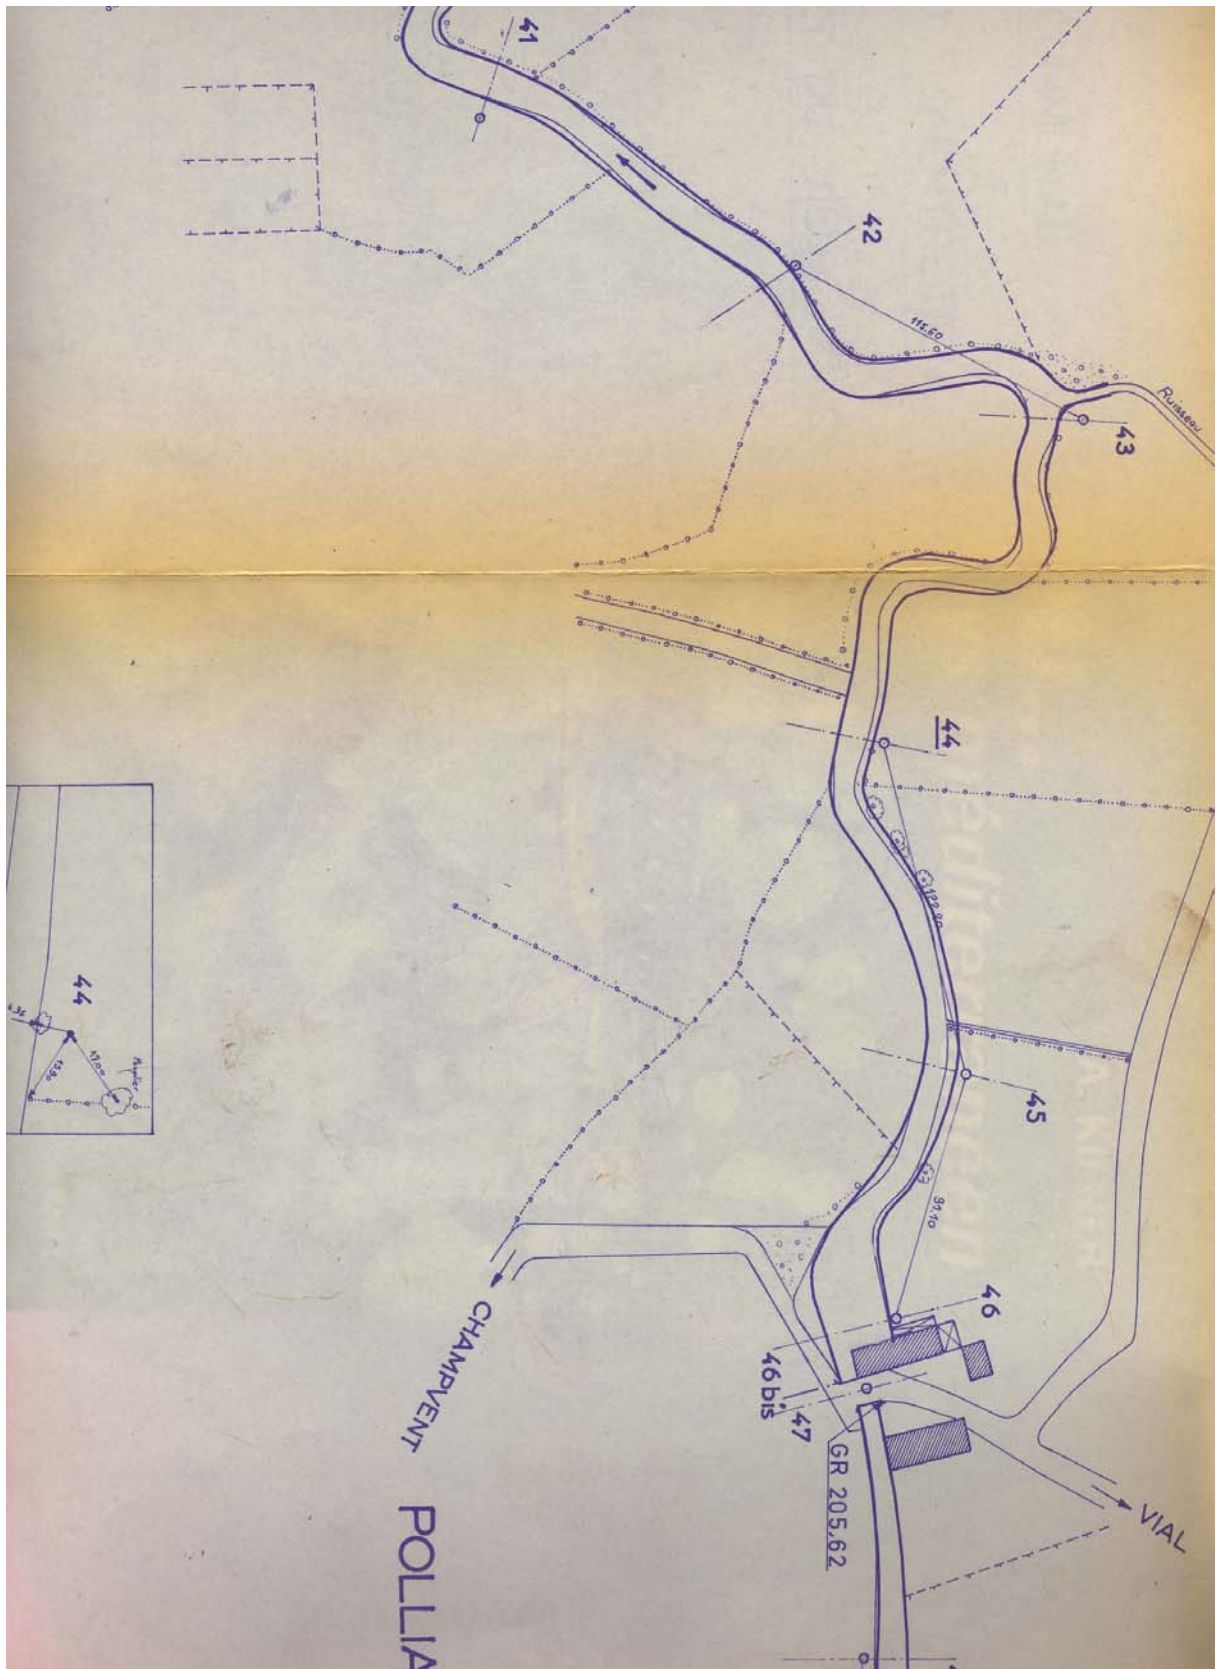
exemple de plan général des travaux sur la Haute Veyle ayant permis de positionner les profils en travers sur le fond scanné IGN.
